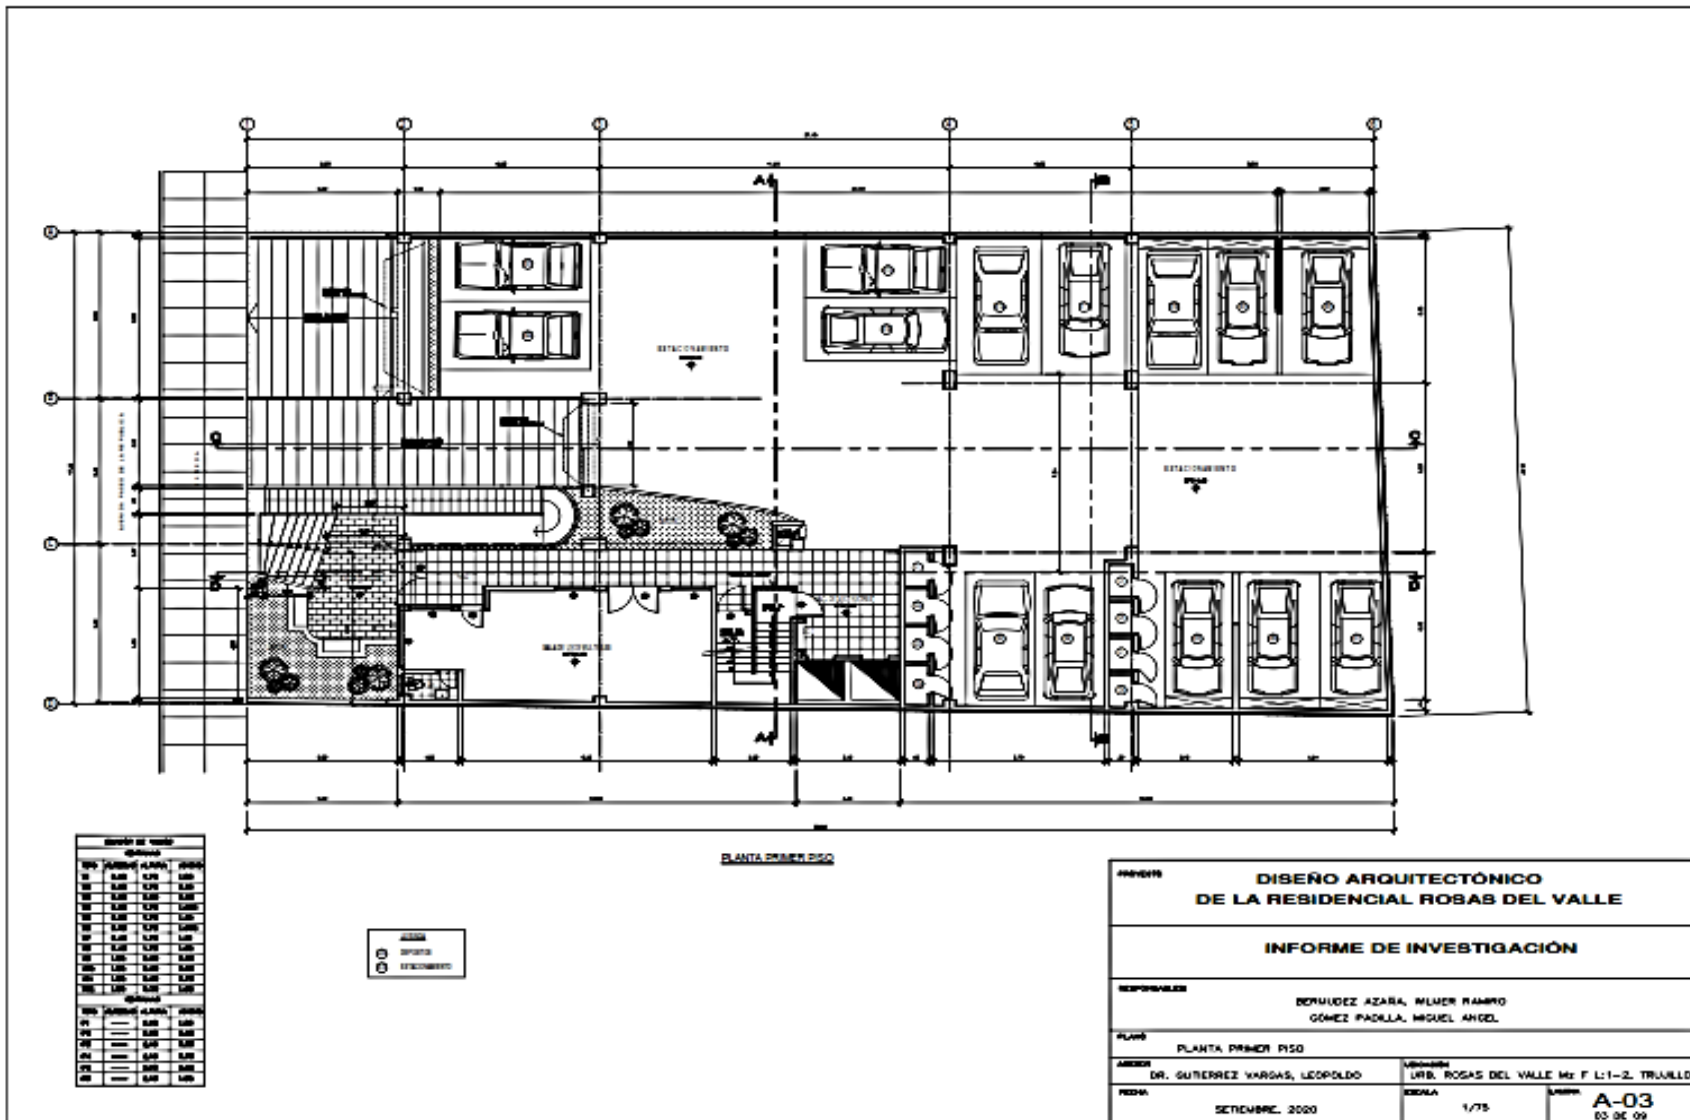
Vista planta primer piso. Fuente: Elaboración propia
